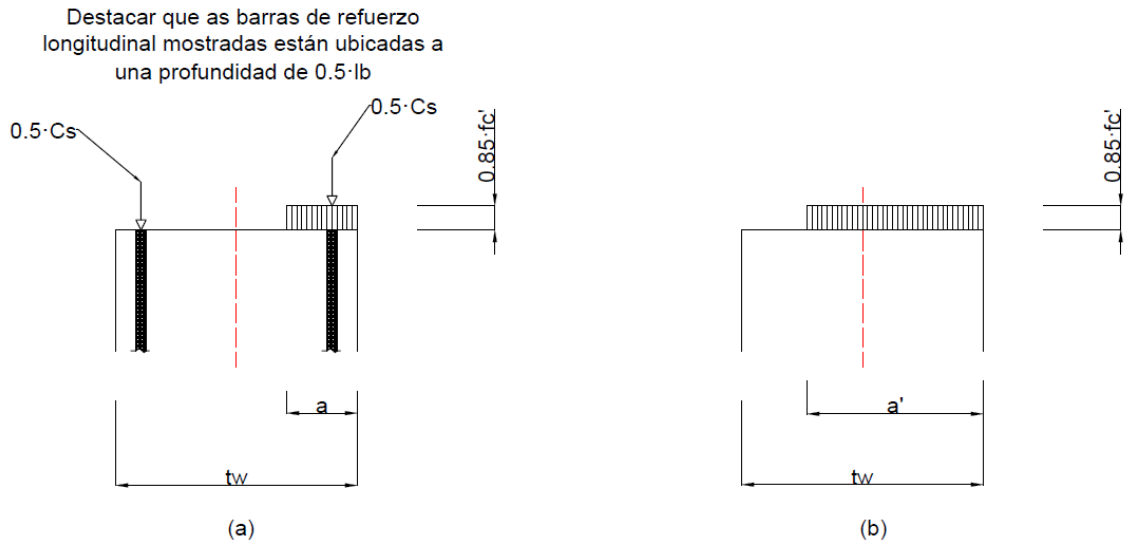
Distribución de fuerzas del hormigón y acero en compresión en la sección transversal. Corte en 1 (a); Corte en 2 (b).
